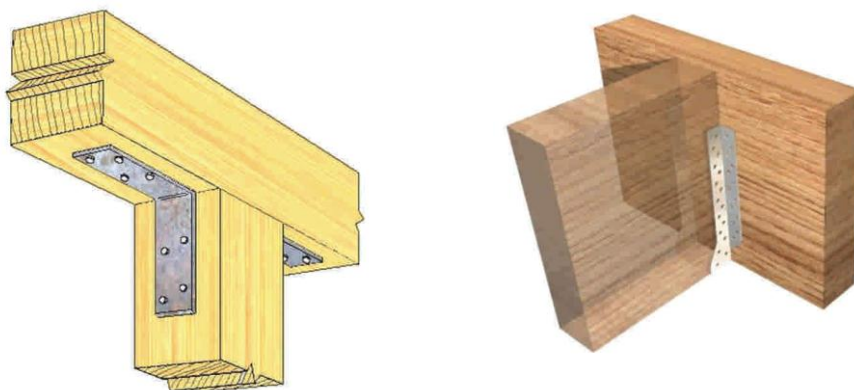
Detalles fijaciones de conectores con elementos estructurales.
